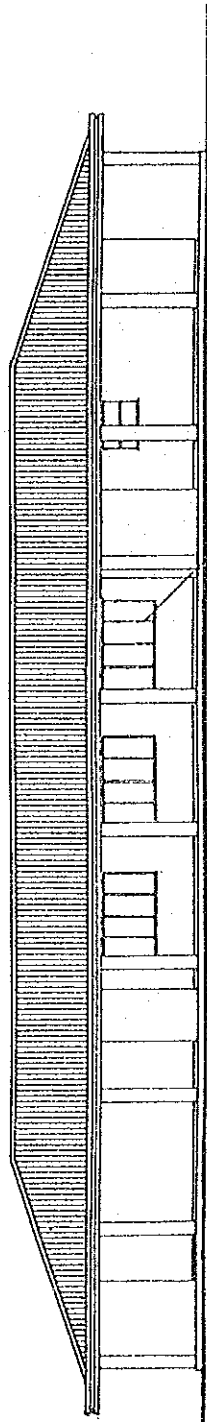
(2)種畜牧場 管理・研究棟 平面図
